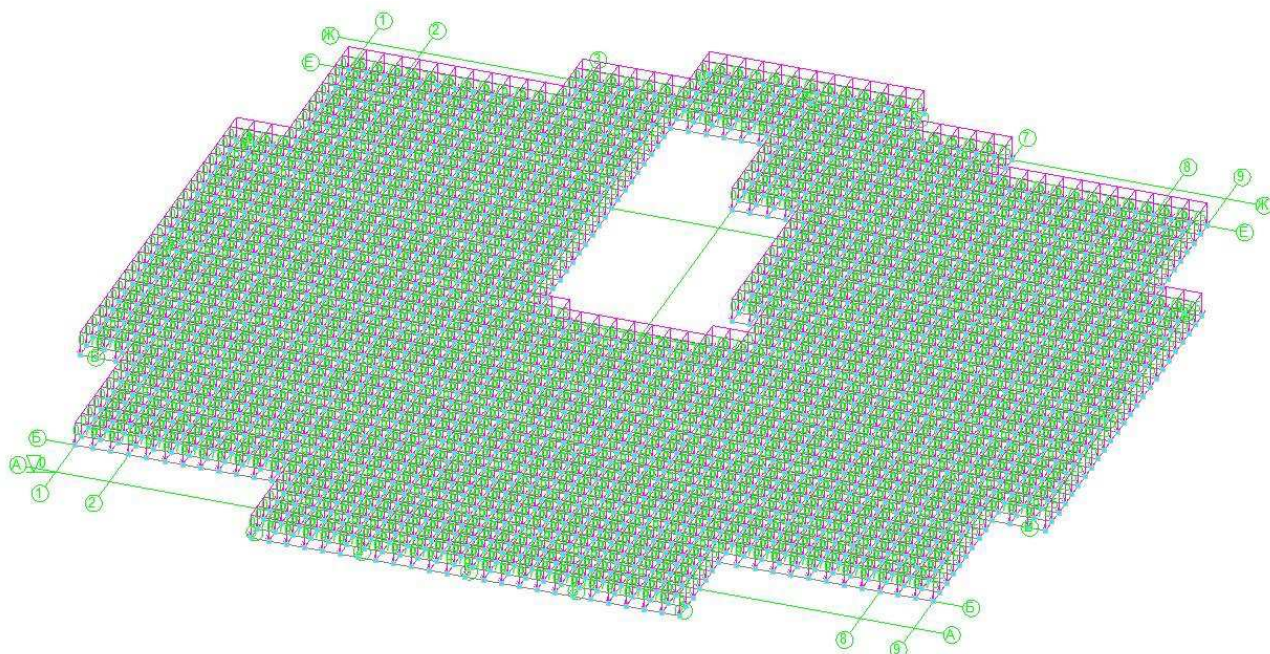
Схема загрузки плиты нагрузкой от веса перегородок
